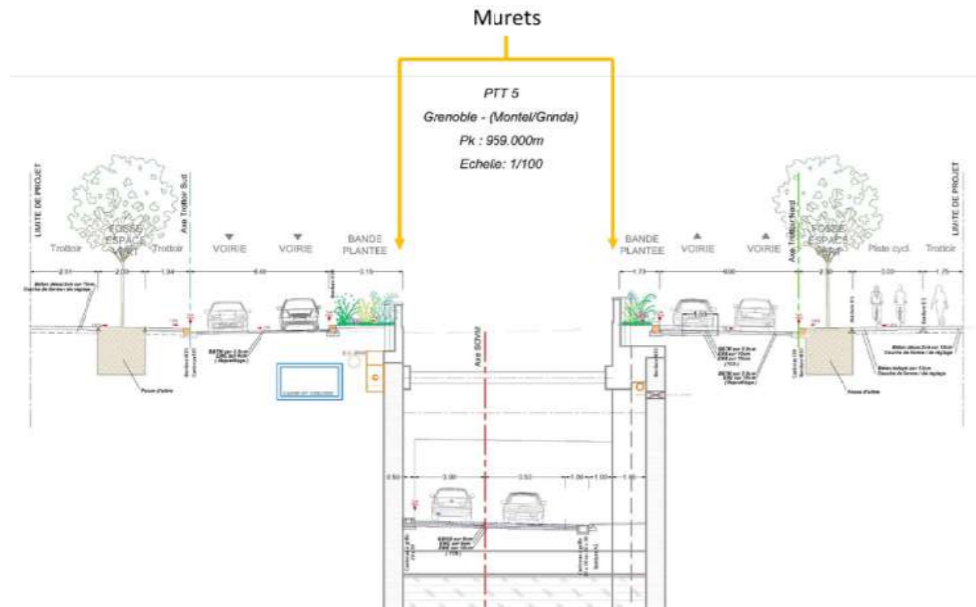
Coupe type tranchée ouverte SOVM phase 1 (Source : DCE travaux plan Ingerop)
